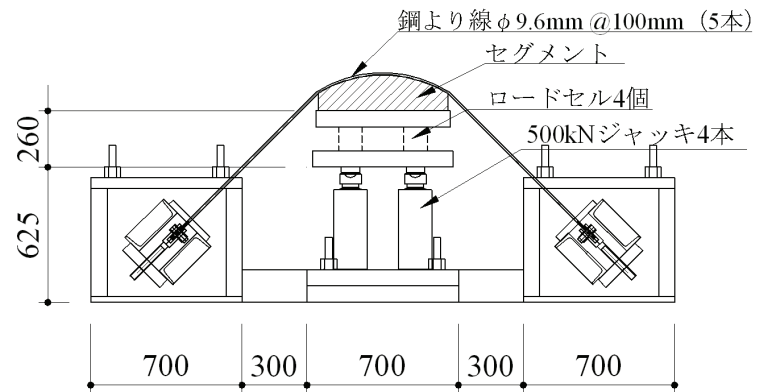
セグメント支圧荷重試験装置 (単位 mm)
